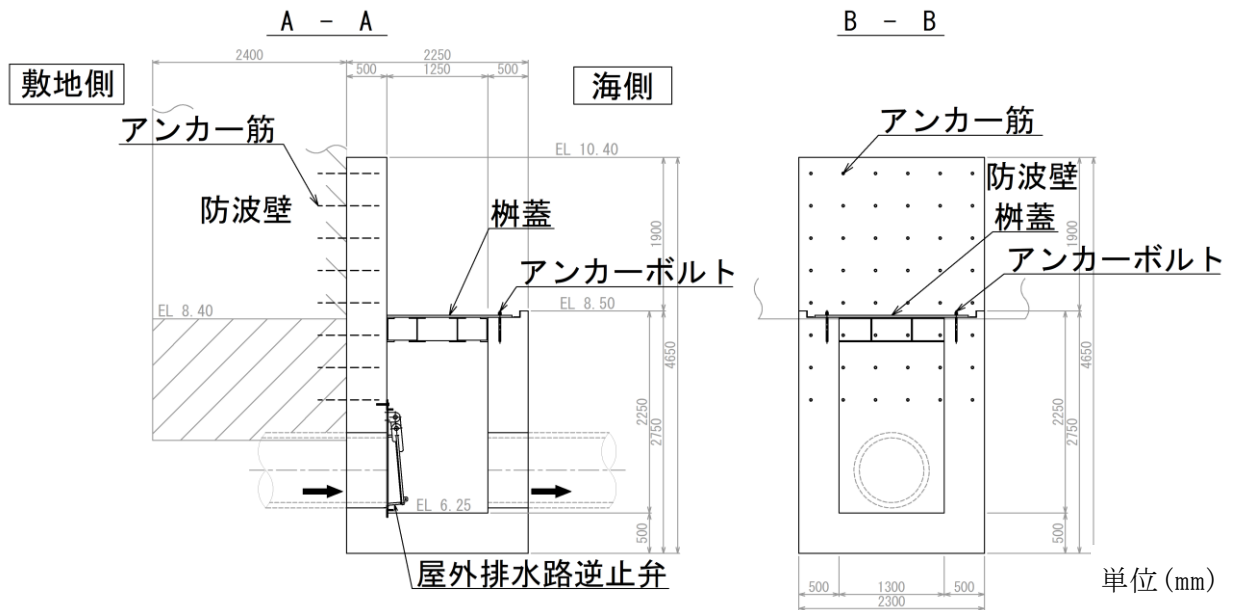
(2) 屋外排水路逆止弁⑩断面図 単位 (mm)
